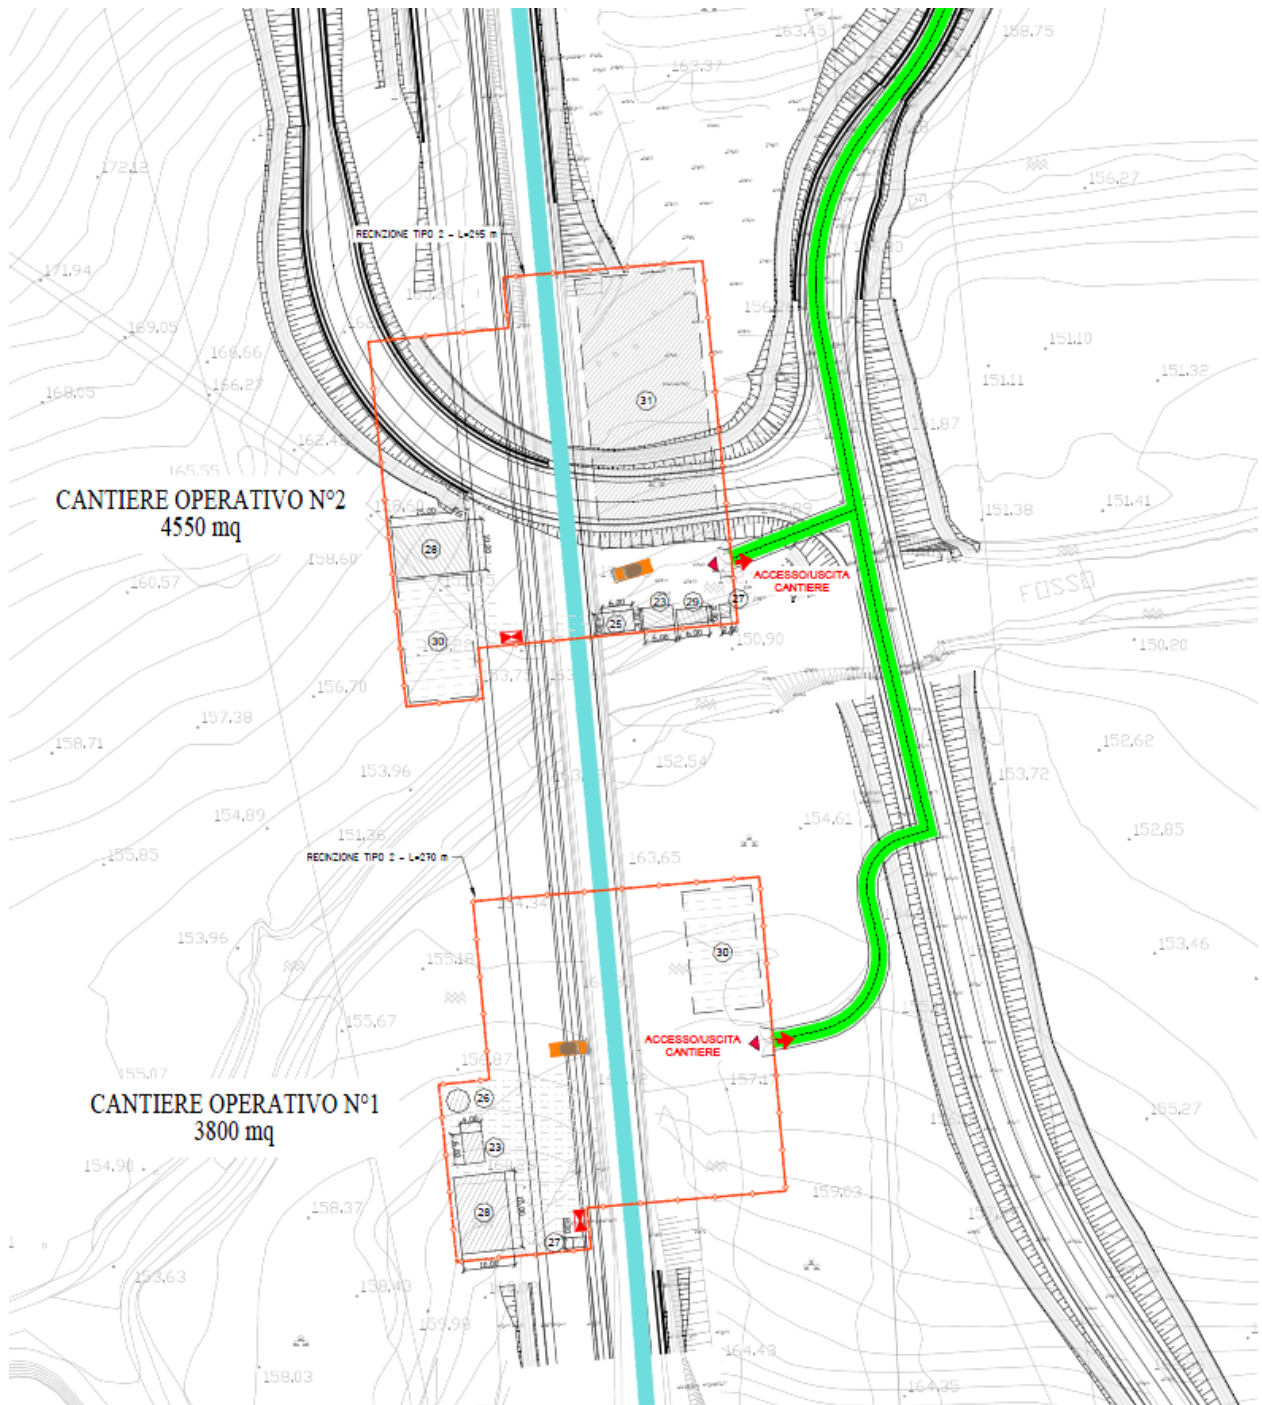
Planimetria cantiere operativo 1 e 2.
